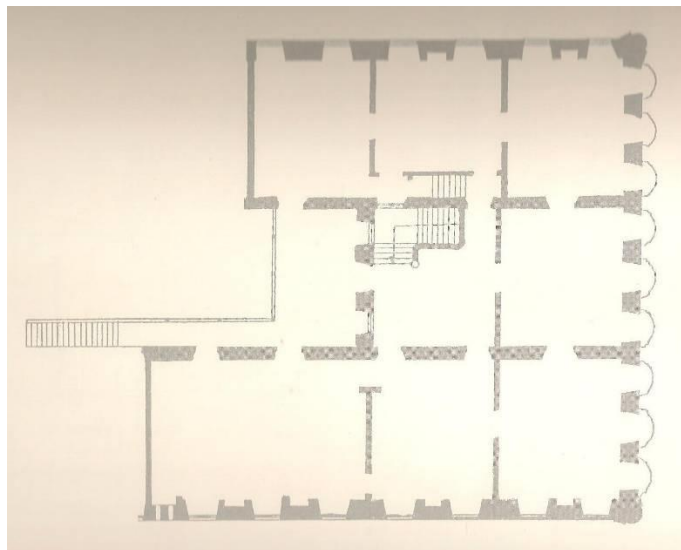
Planta baixa do pavimento superior, ou andar nobre, da Casa dos Contos em Ouro Preto, Minas Gerais. Possível configuração do prédio em 1784.
